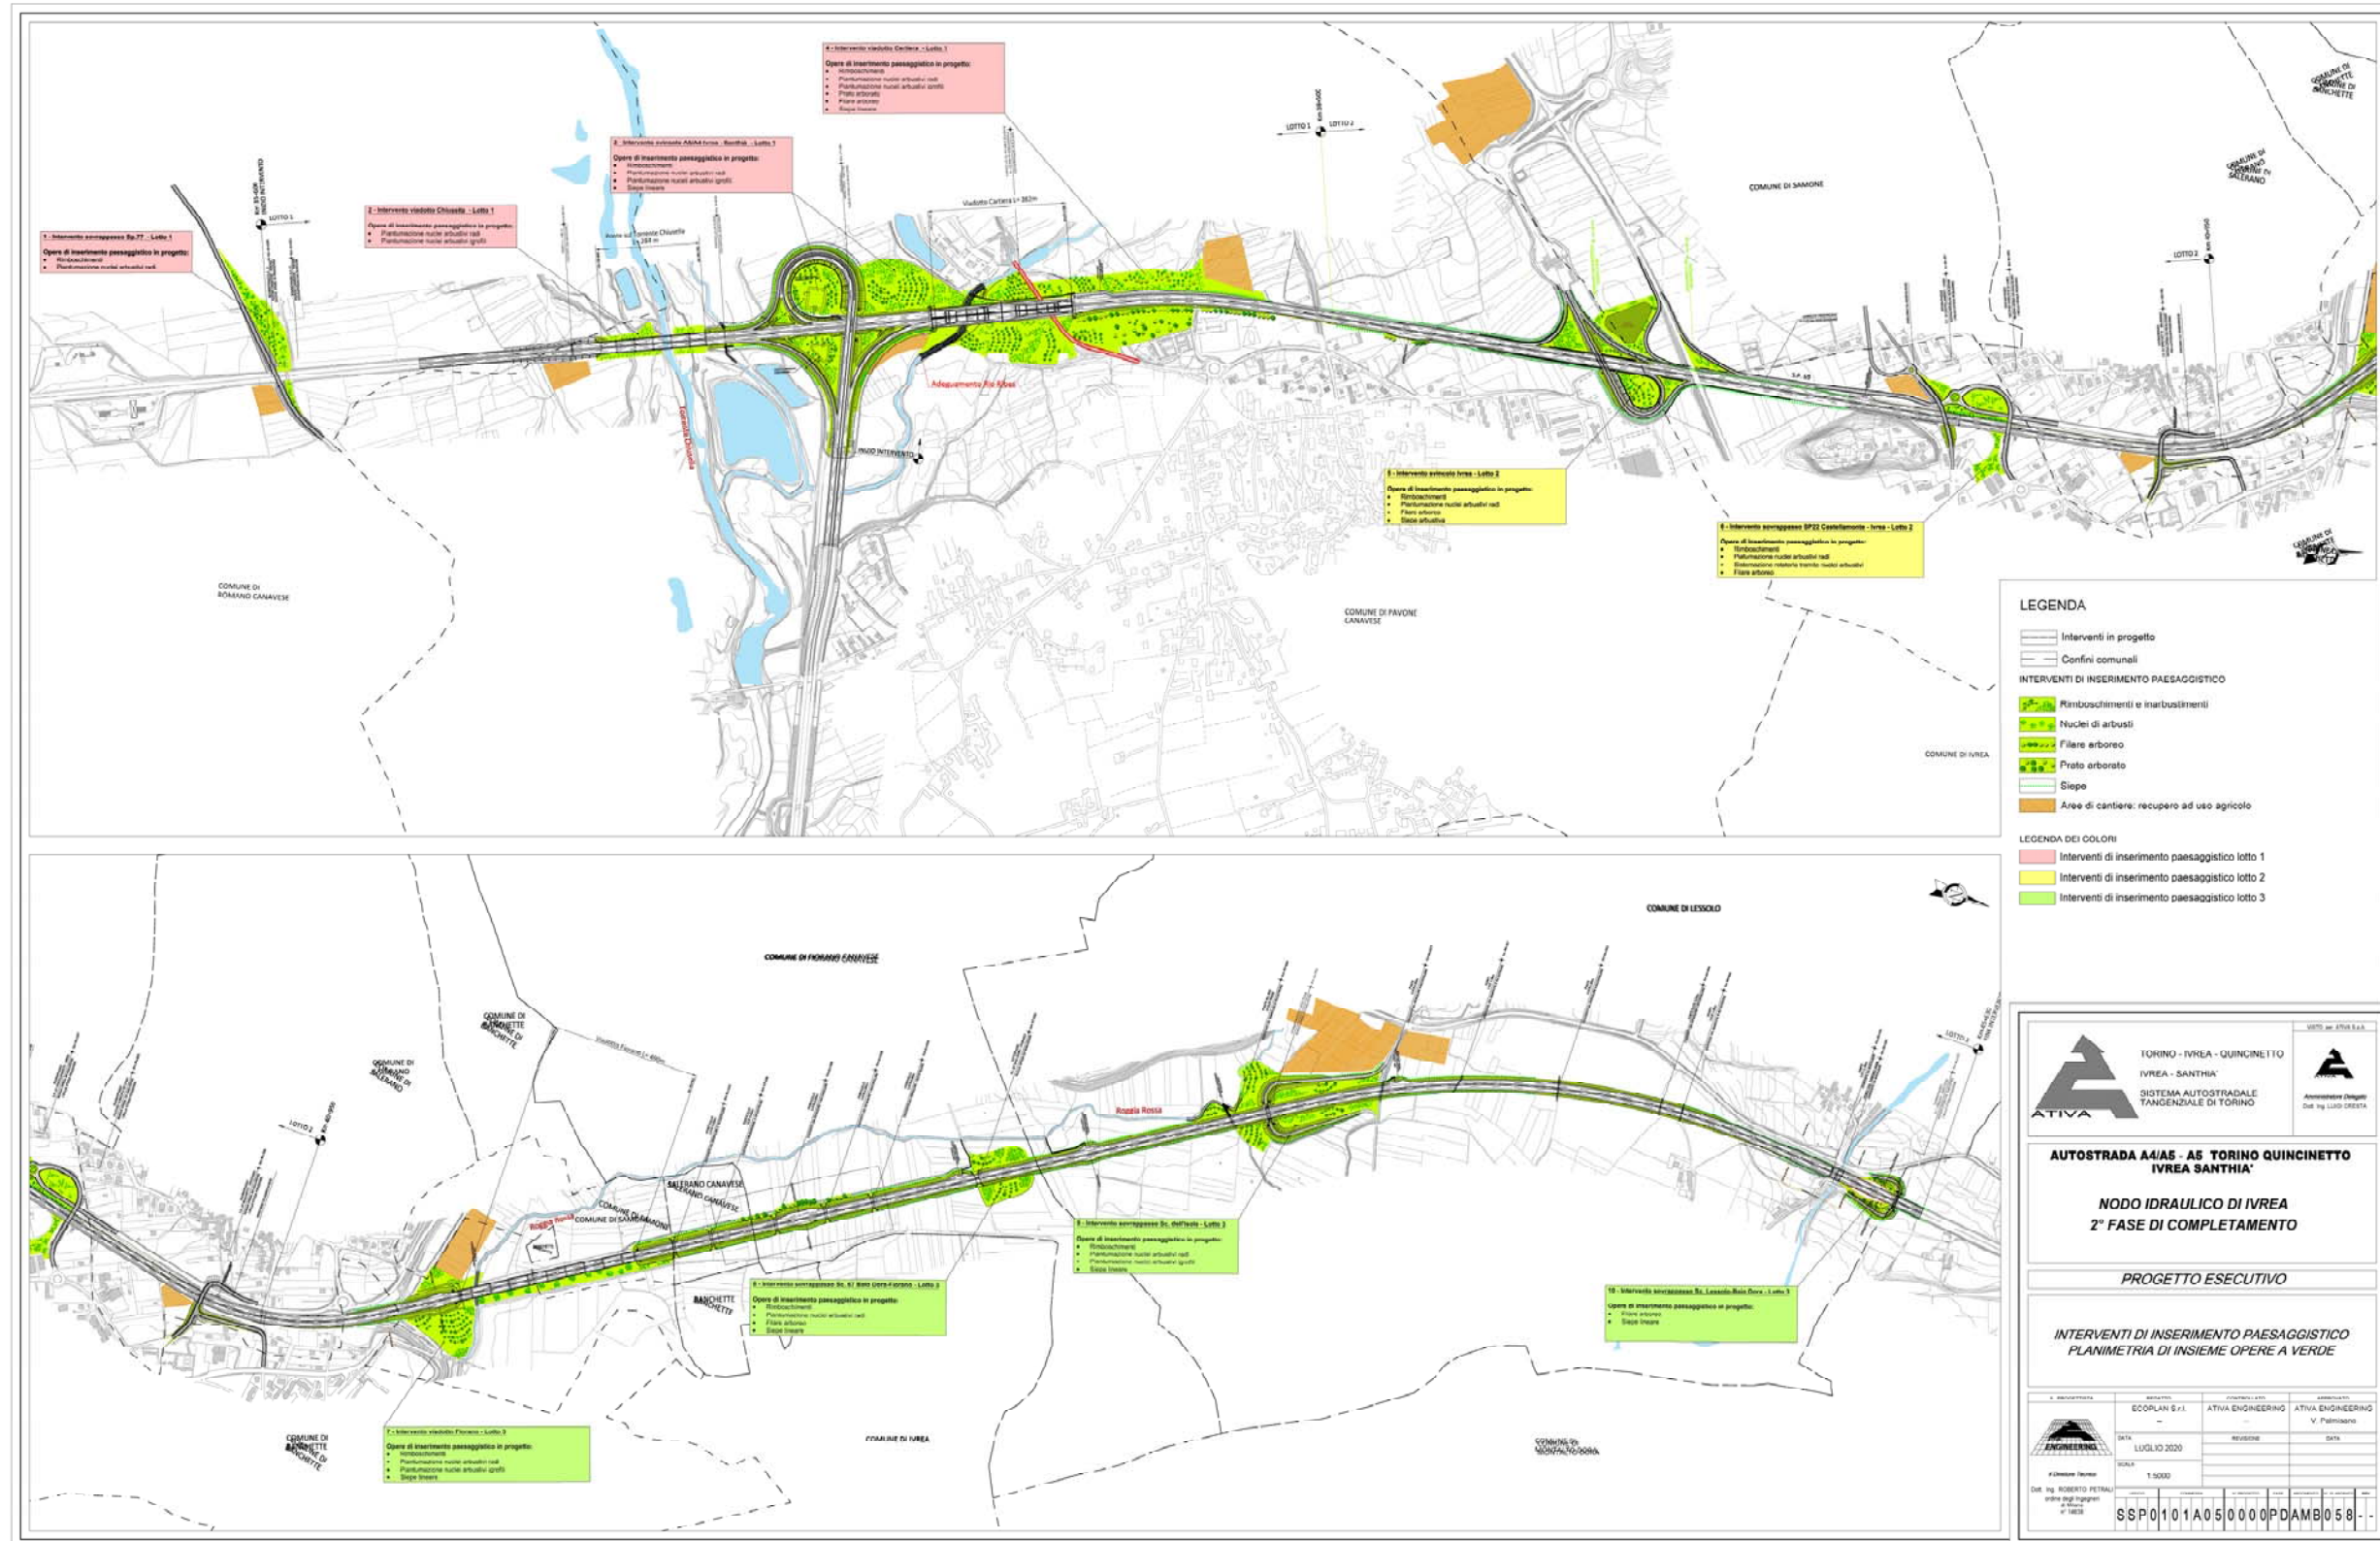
/1: stralcio planimetrico della corografia di insieme delle opere a verde in progetto
